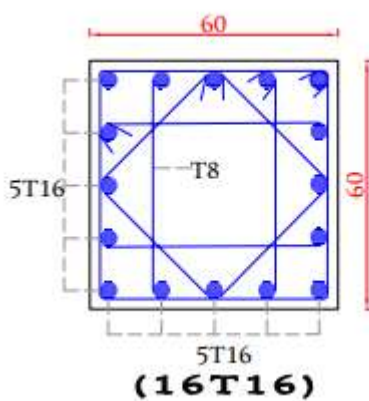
Poteau de niveau :8<sup>ème</sup> étage
